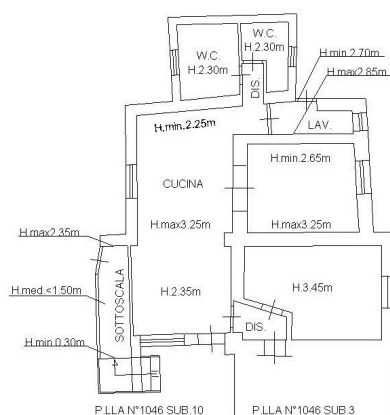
Planimetria catastale dell'appartamento oggetto di stima part. 1046 sub 11
